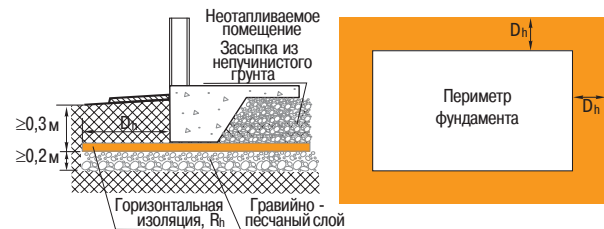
Схема поперечного разреза и план расположения изоляционных плит «Пеноплэкс®» для неотапливаемых помещений
